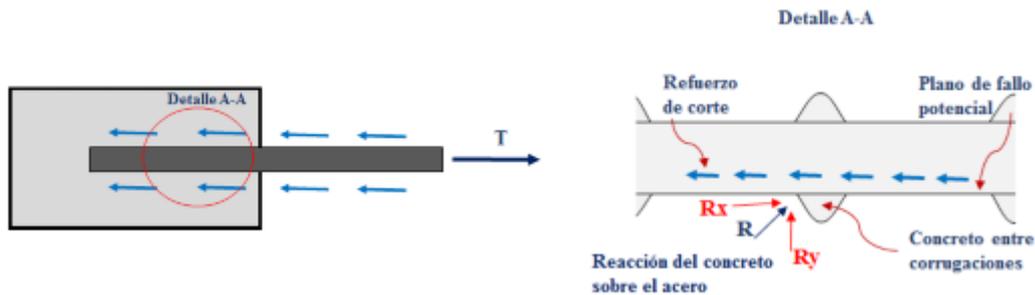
Aplastamiento del concreto entre corrugaciones de las barras de acero de refuerzo
